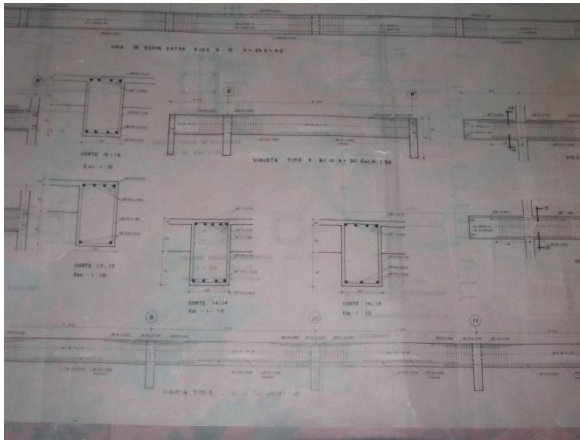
PL 14/22 vigas losa ejes 6 – 12
